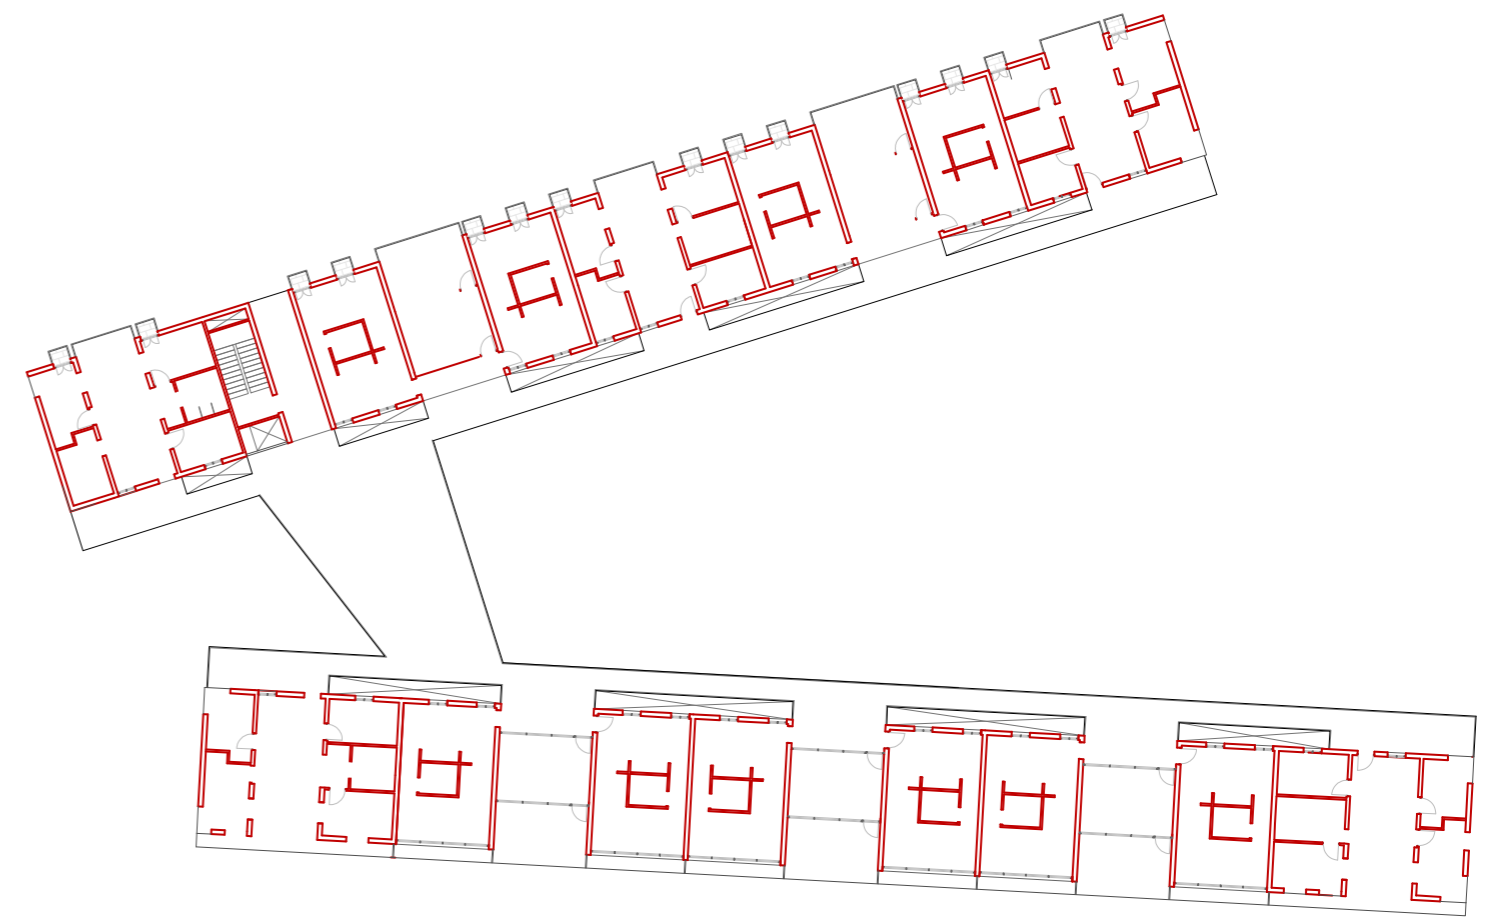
Resistencia al fuego de la estructura en planta baja. Elaboración propia.
